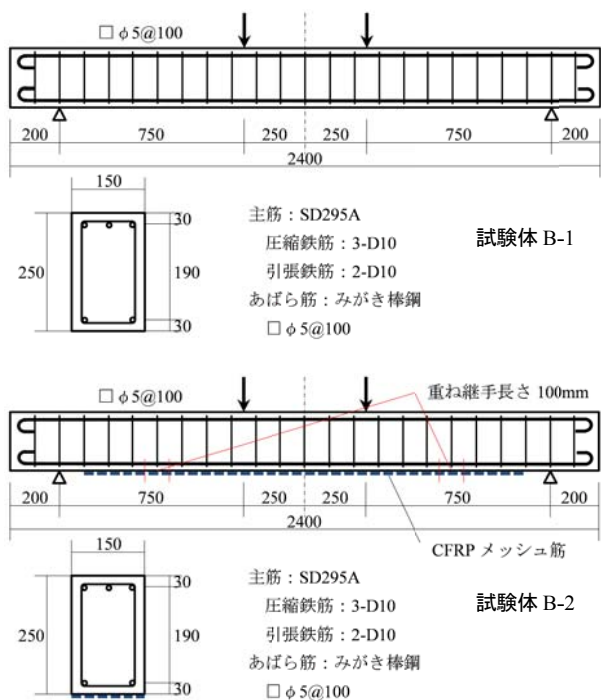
曲げ試験シリーズにおける試験体形状寸法, 配筋および荷形式
